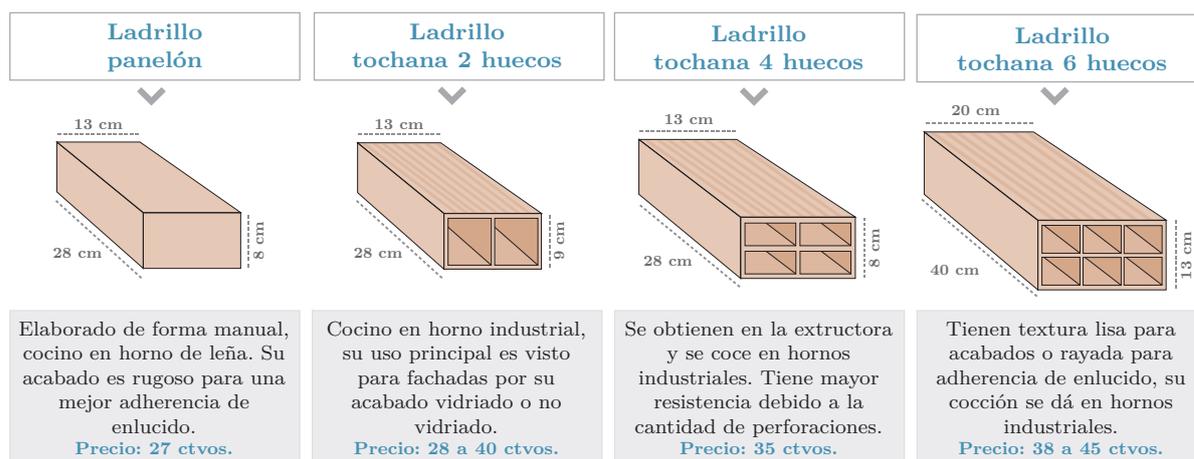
Tipo de ladrillos utilizados localmente. Fuente: Cárdenas (2019). Elaboración: Autora.
